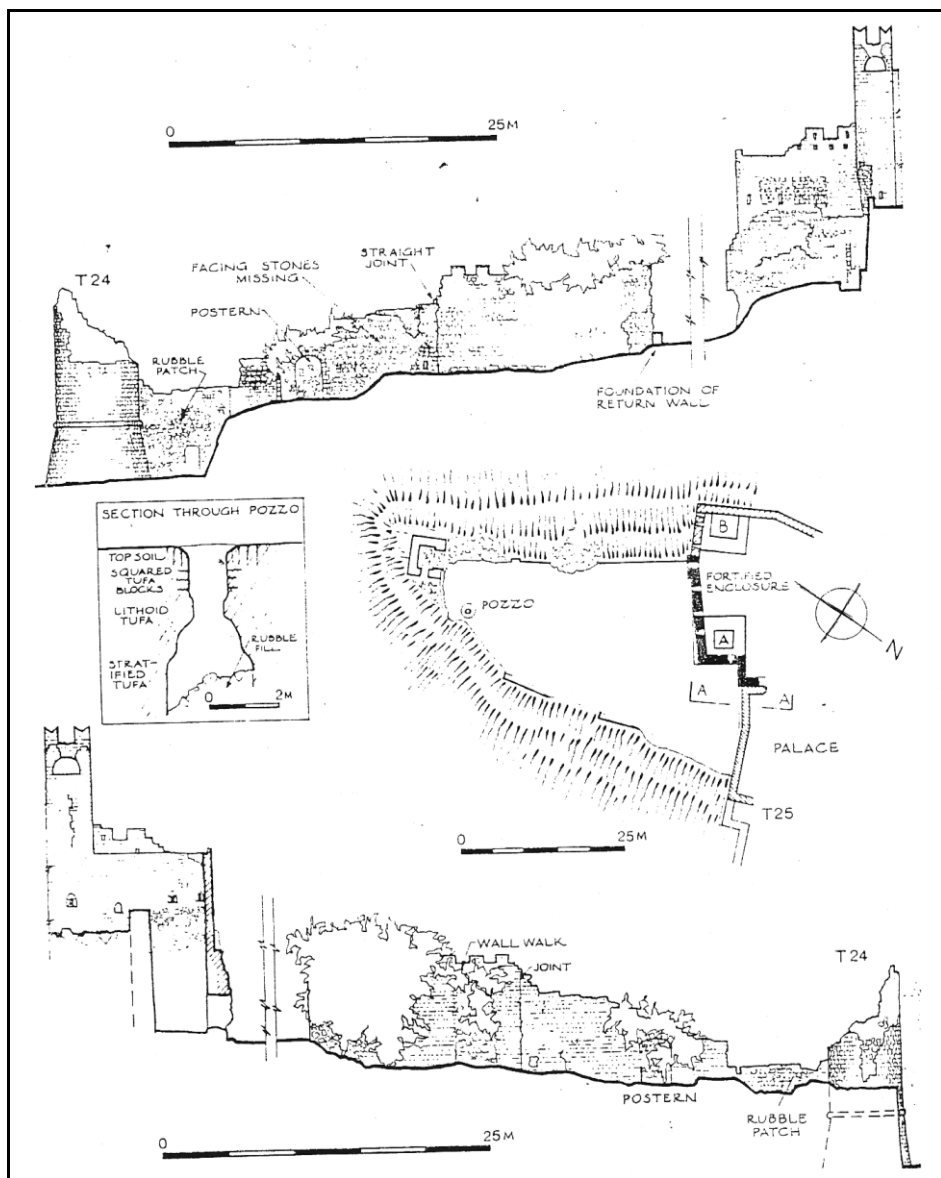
Rilievi di S. Gibson (*Alzato della parte ovest del complesso, pianta della piazza d'armi e sezione del pozzo*).
